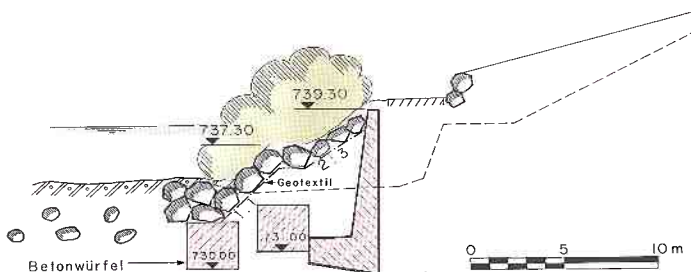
Hauptschutzelement B: Überdeckte Betonmauer, sekundärer Blockwurf und diagonal halbierte Betonwürfel (Kantenlänge 2,75 m). Lage des Querschnittes siehe Bild 8.
